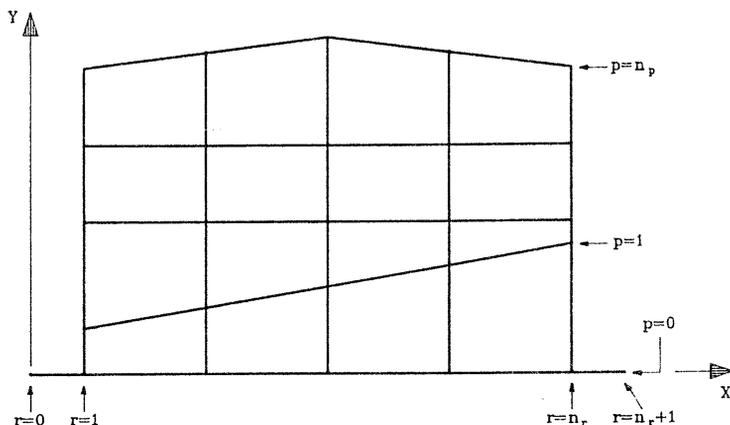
Telaio a maglie trapezie con trave di fondazione
